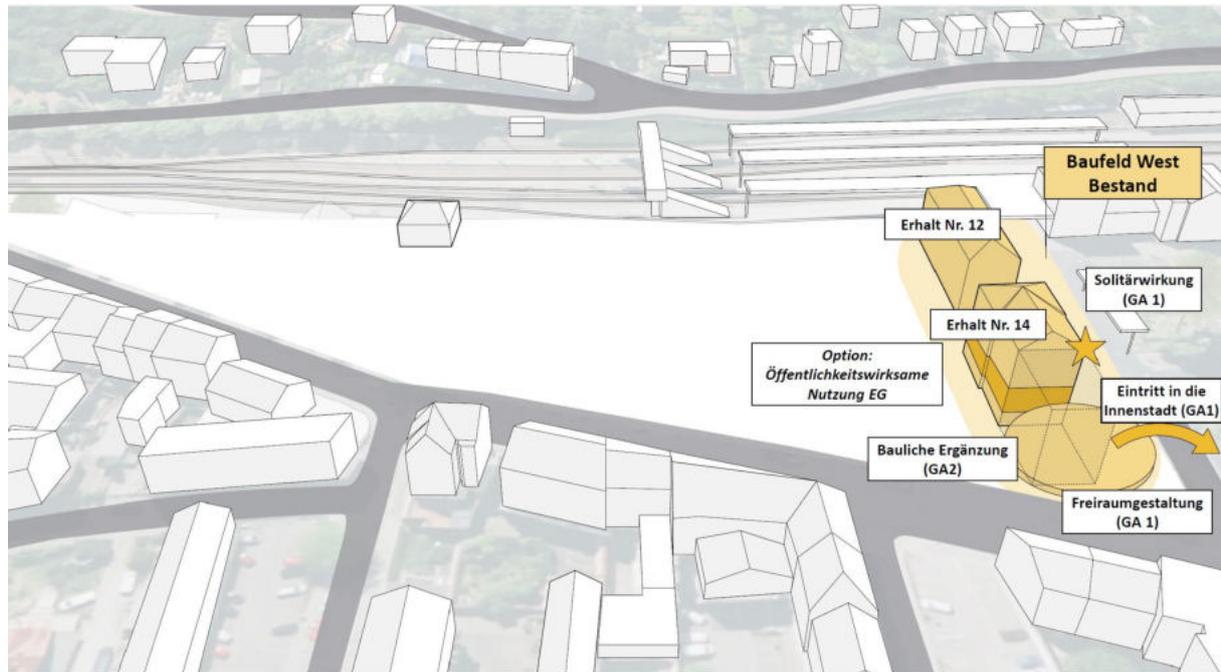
Städtebauliche Leitidee Baufeld West – Grundansatz 1 (GA1) Freiraumgestaltung, Grundansatz 2 (GA2) mit baulicher Ergänzung
